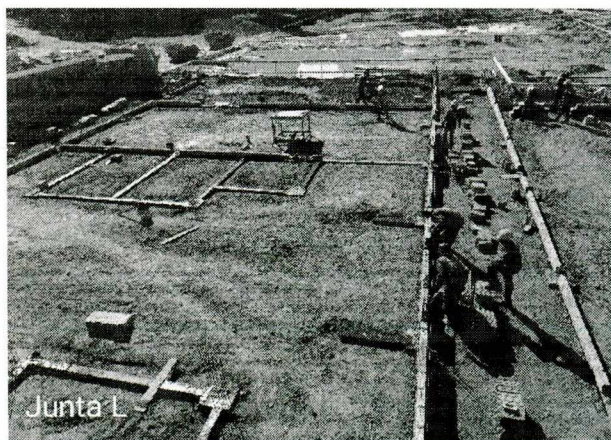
a 44: concretagem de blocos e baldrames; execução de alvenaria de primeira e segunda etapa; montagem do escoramento e montagem das vigas de cobertura.
